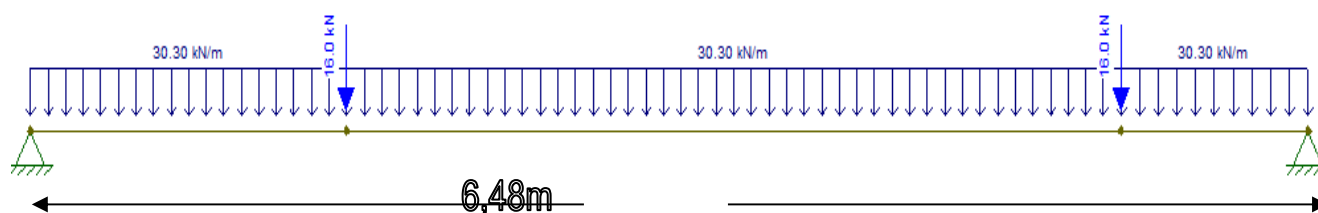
Schema statico Tegolo tipo piano secondo zona Expo
